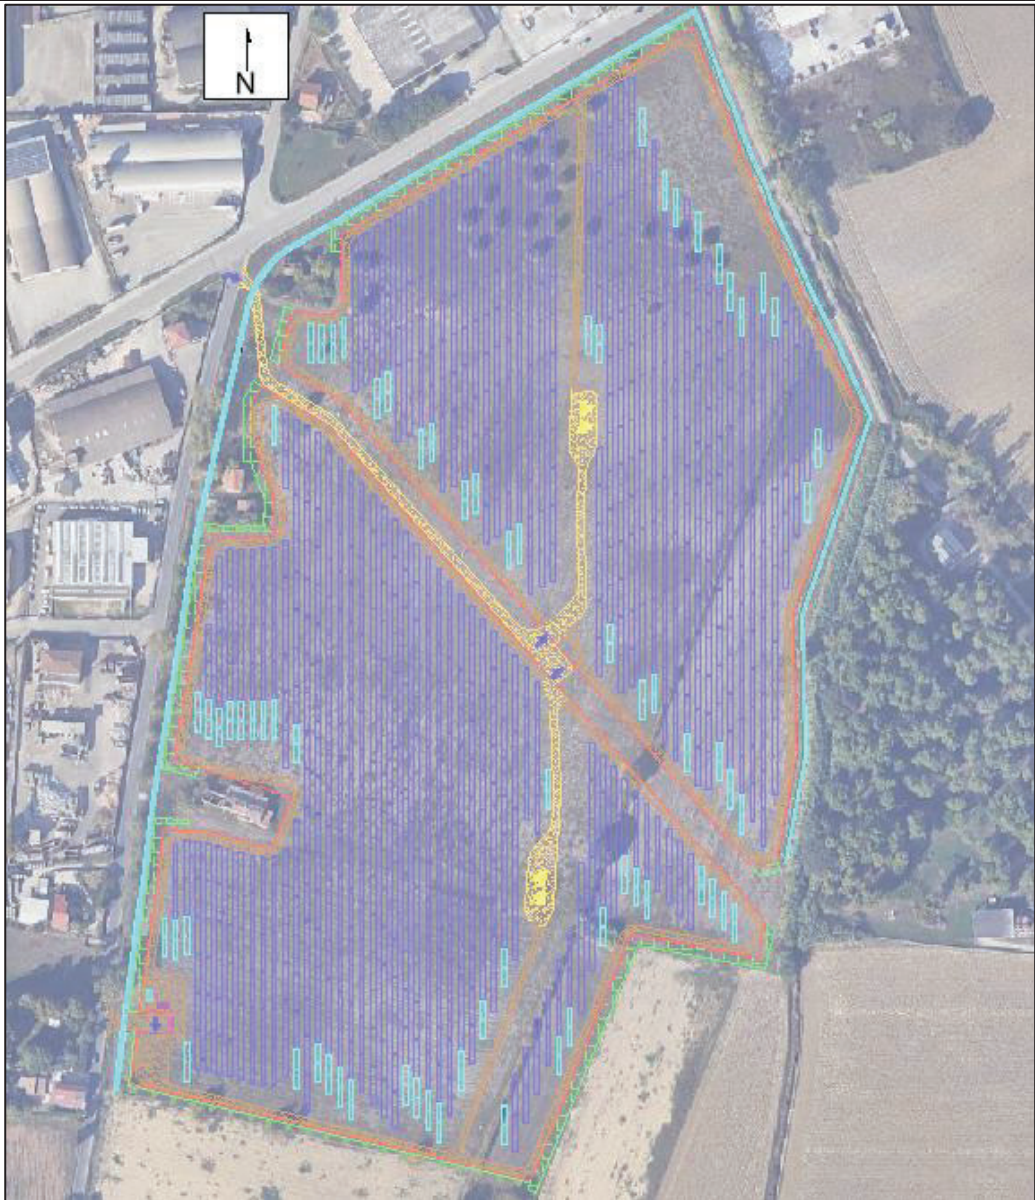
Sovrapposizione su ortofoto del layout di progetto (Fonte: Google Earth)
